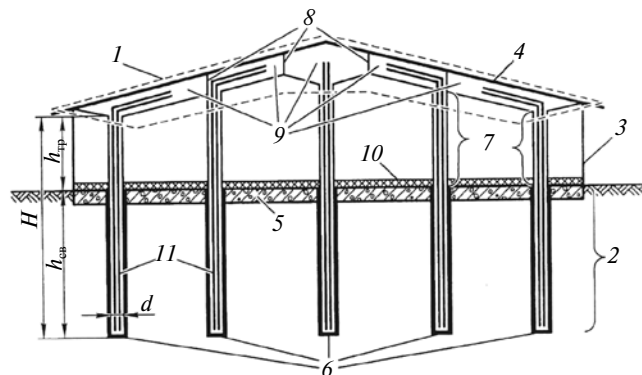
Схема здания на вечной мерзлоте с охлаждающей камерой, расположенной на крыше (дизайн первого типа): 1 – камера для охлаждения грунтов; 2 – свайное основание из термопор; 3 – корпус здания; 4 – крыша; 5 – ростверк фундамента; 6 – пустотелые сваи; 7 – транспортный участок для воздушных потоков; 8 – перемычки камер; 9 – отдельные подкамеры; 10 – теплоизоляция; 11 – коаксиальные вставки для разделения восходящих и нисходящих воздушных потоков
